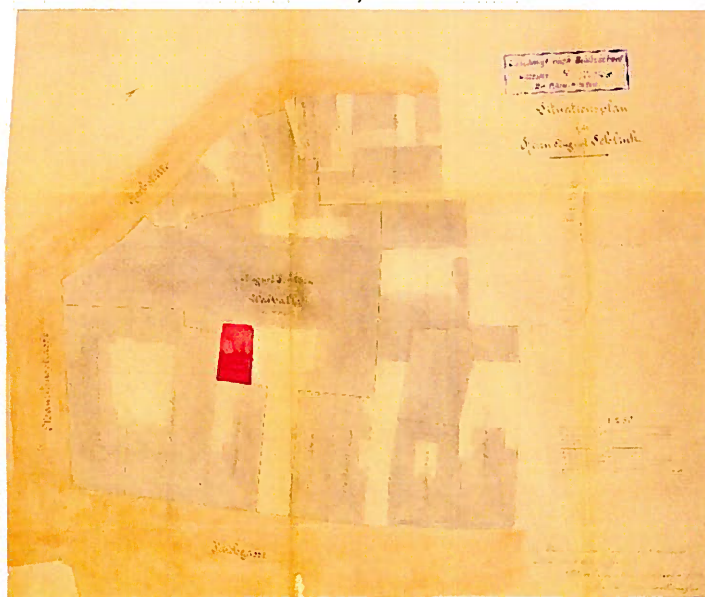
Lageplan 1889, Bauakte Stadt Wiesbaden
